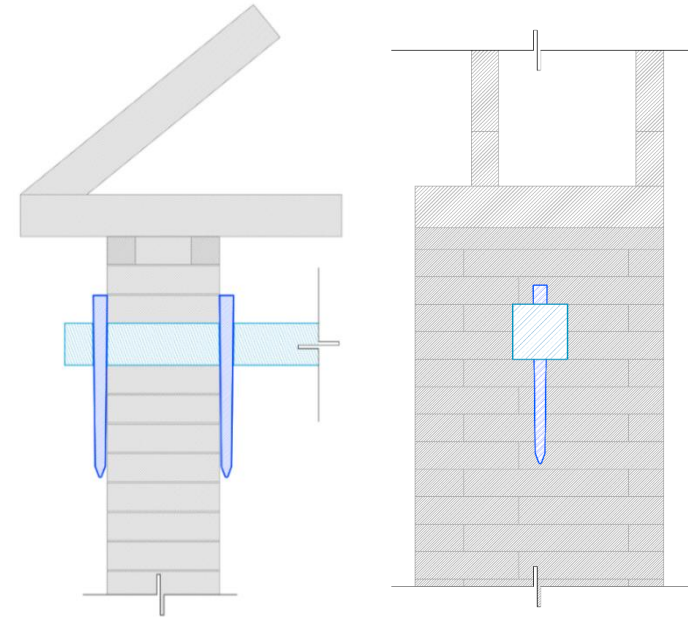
Sección de detalle de dispositivo DP instalado en muros. Fuente: Elaboración propia.
